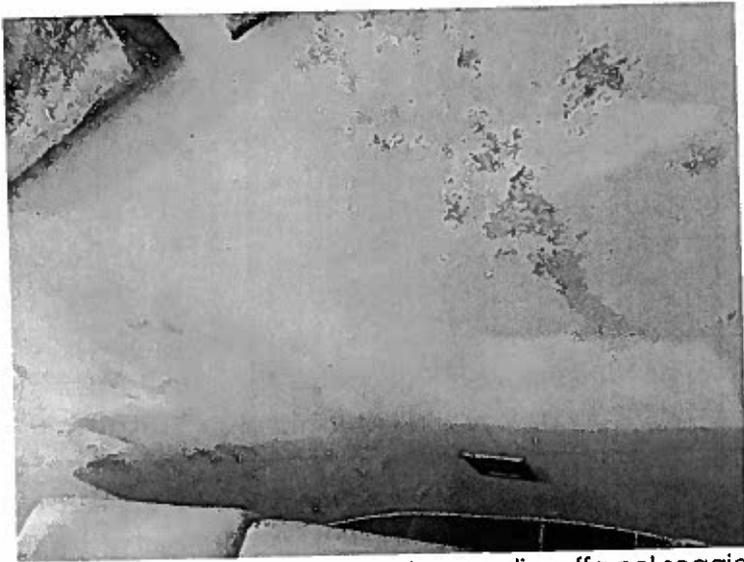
Piano terra, parete con tracce di muffa nel soggiorno
